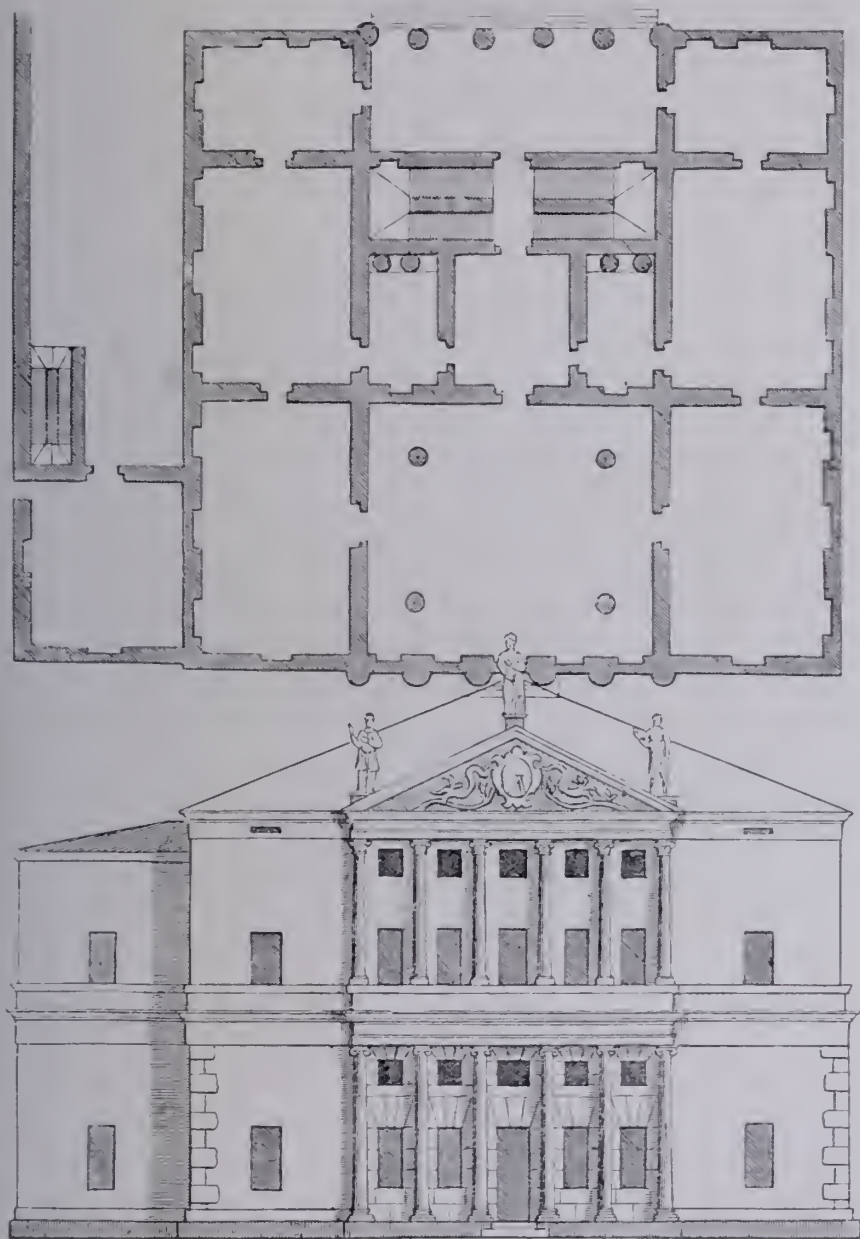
Udine, Palazzo Antonini. Palladio: Pianta e prospetto.
